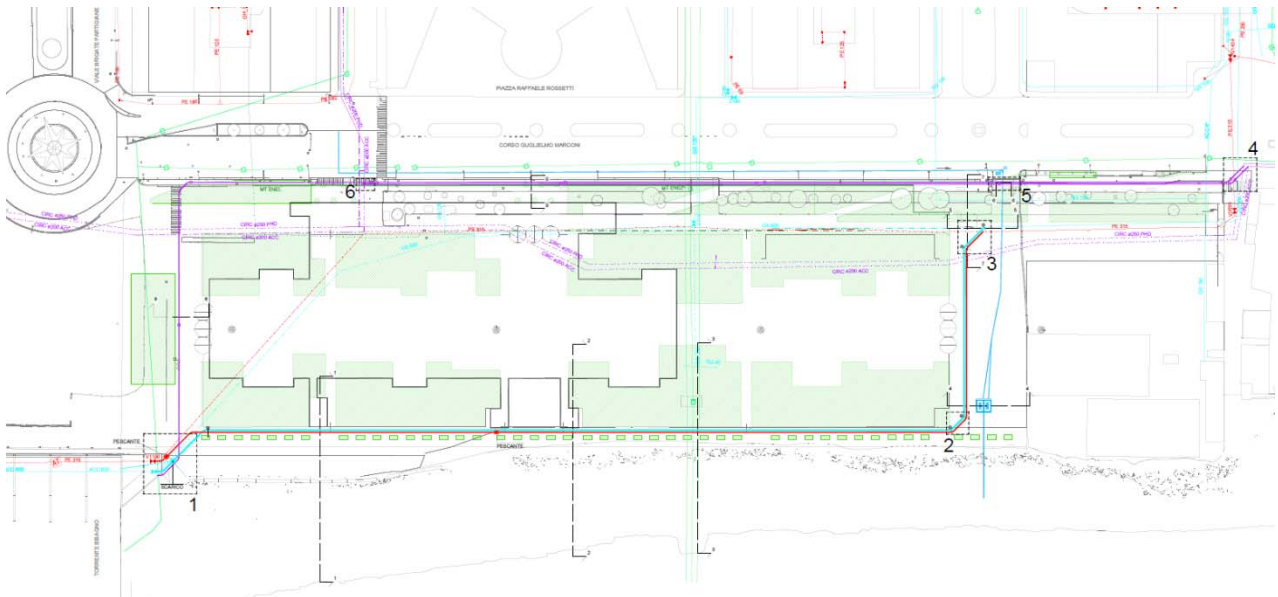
Planimetria di progetto spostamento sottoservizi con individuazione autorimessa e le aree verdi previste
